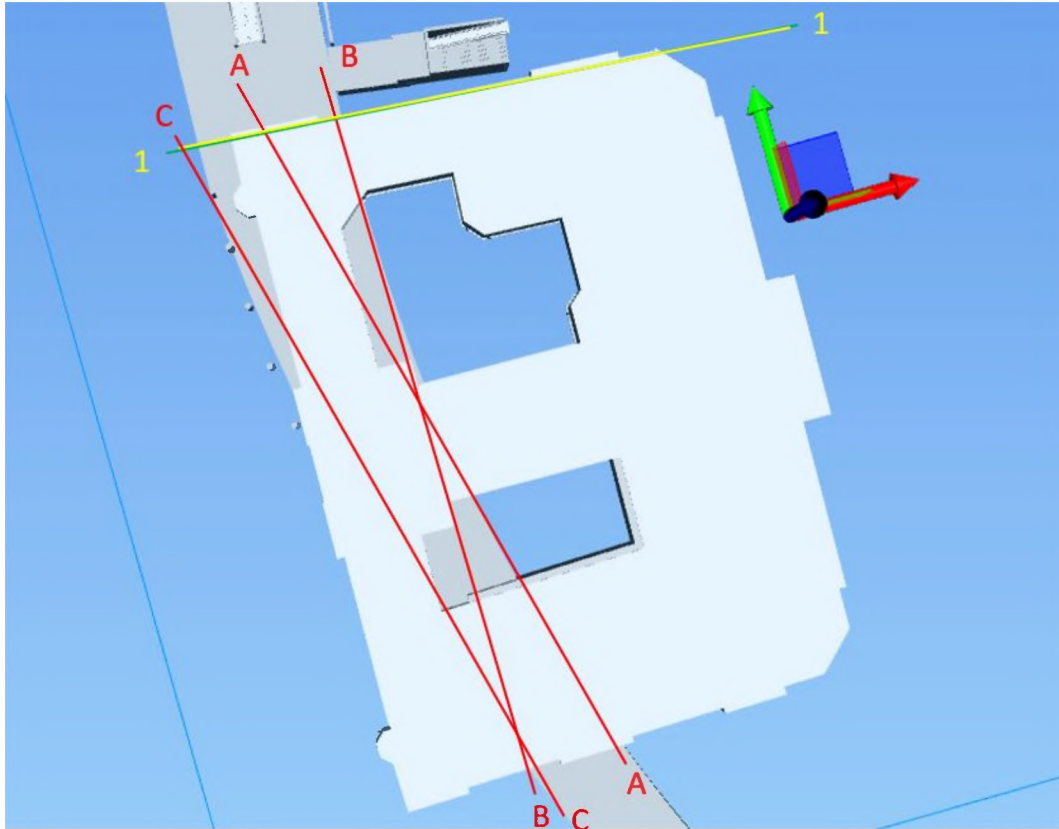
Plansicht Museum für Kunst und Gewerbe mit Schnitten
